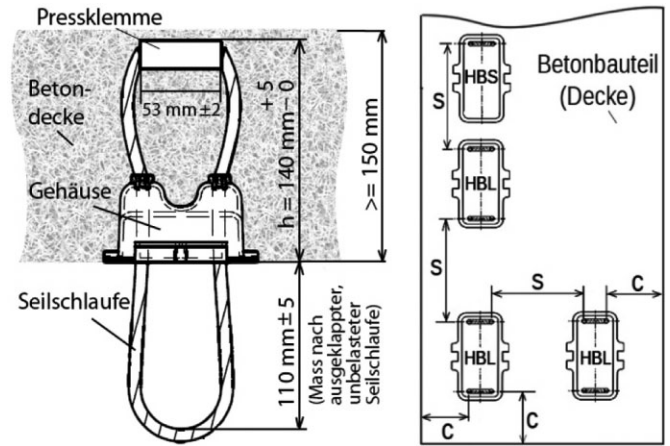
Links: Abmessungen der eingebauten Schlaufenbox; rechts: Abstände der Schlaufenboxen in Betondecken
